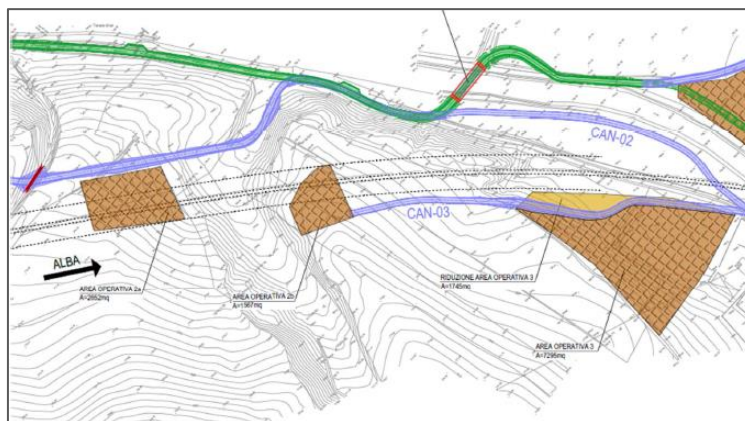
Stralcio planimetrico Aree Operative 2 e 3
